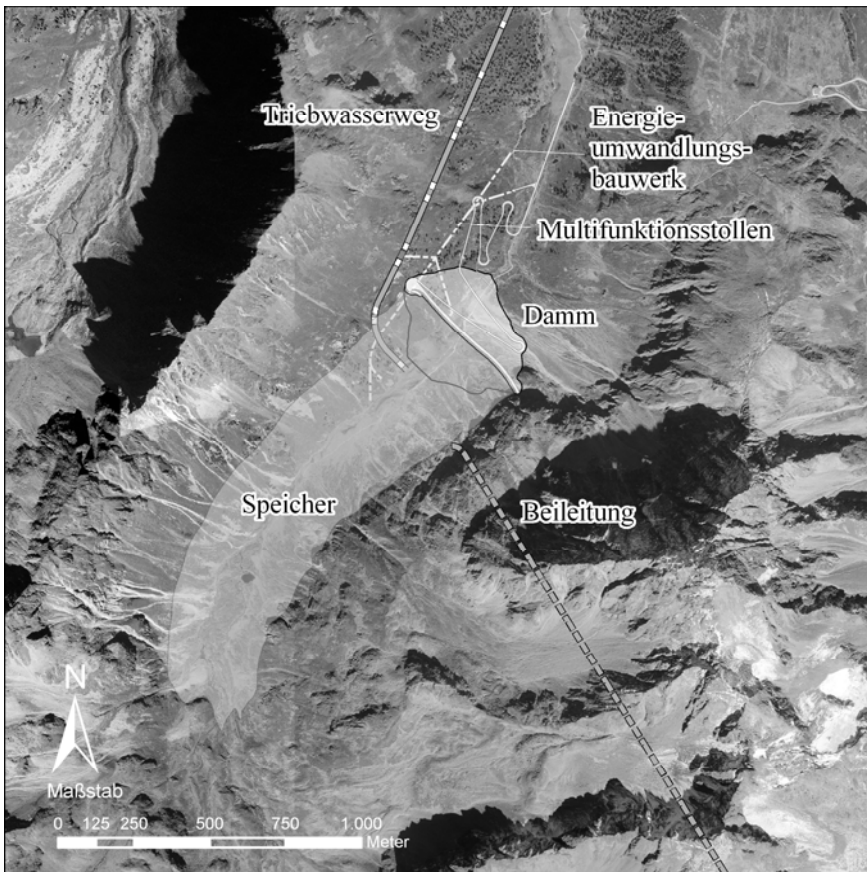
Lageplan Speicherkraftwerk Kühtai.
